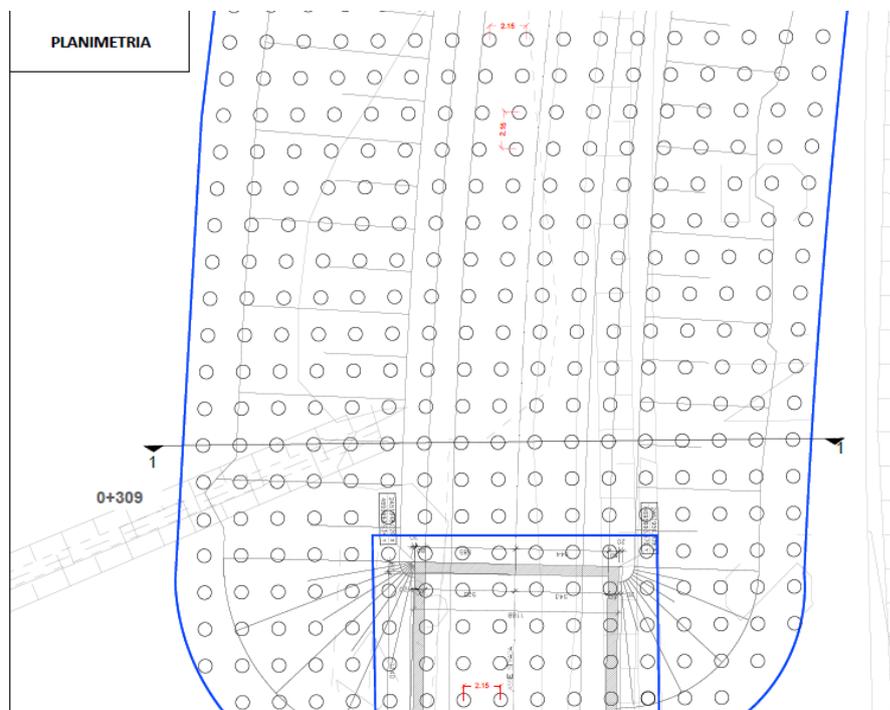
Sezione rappresentativa tratta IV01 - rilevato - planimetria
